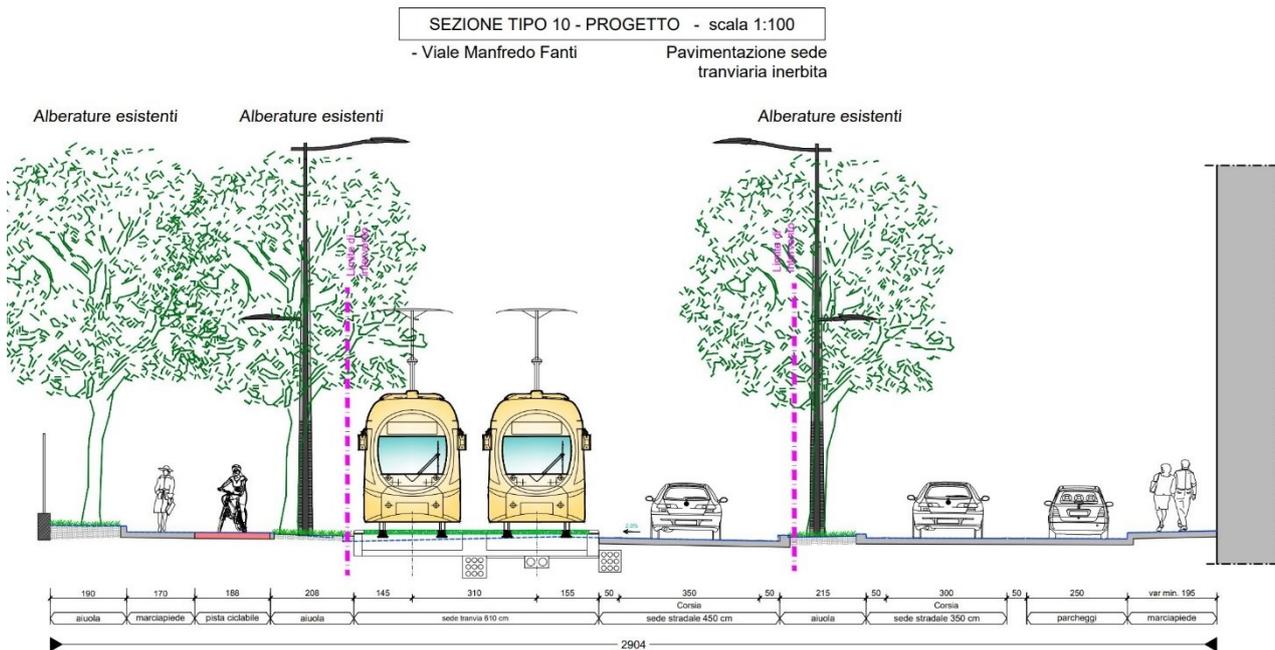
Sezione di progetto su viale Fanti nel tratto ovest
